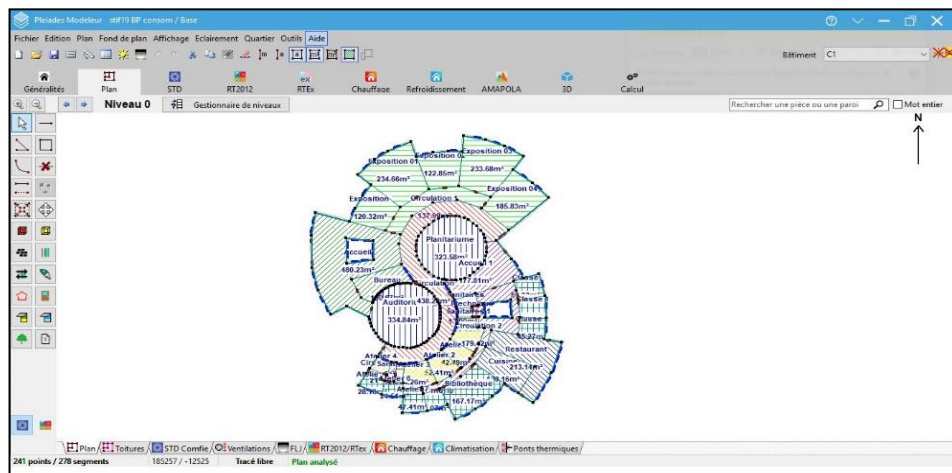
Le plan en 2D sur Pléiade (Source : auteur)
